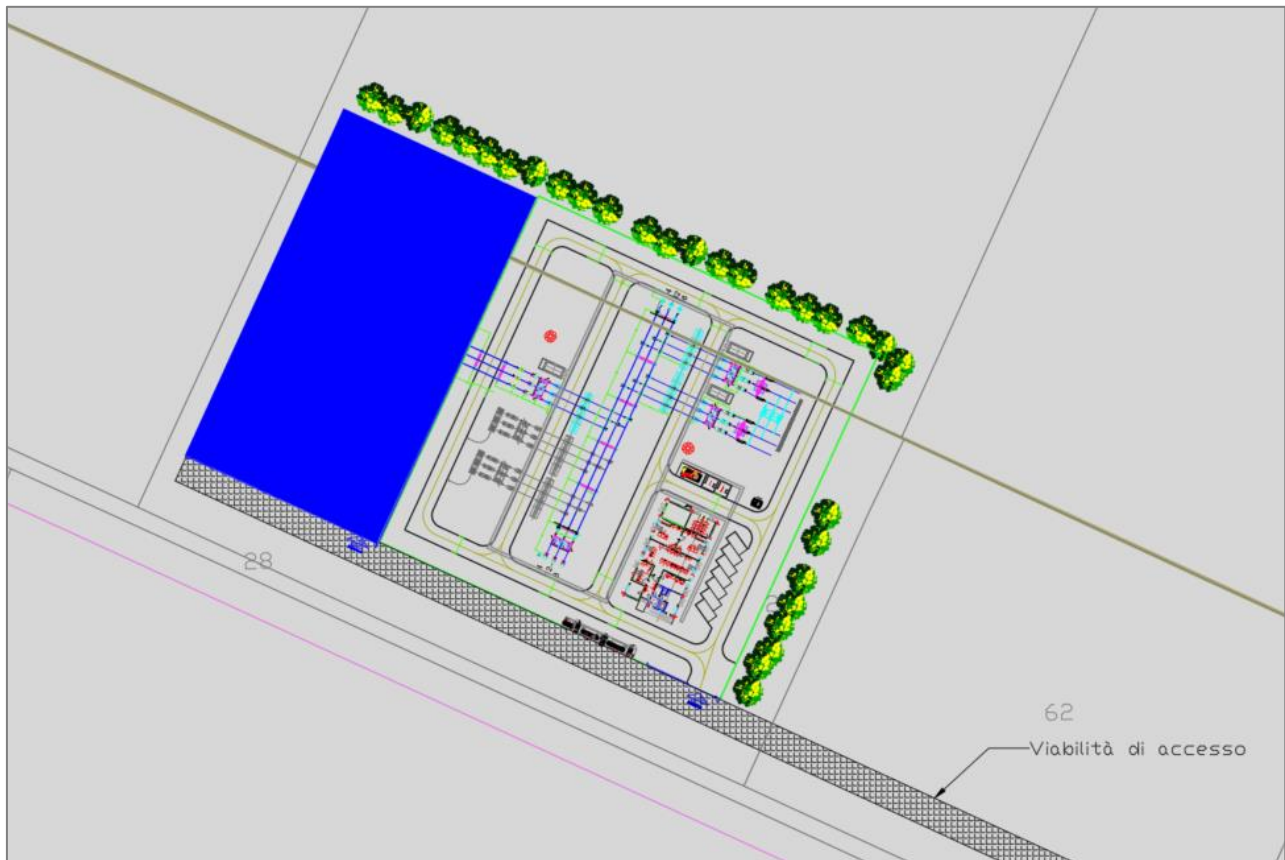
Layout futura stazione RTN (in blu area della sottostazione utente)
